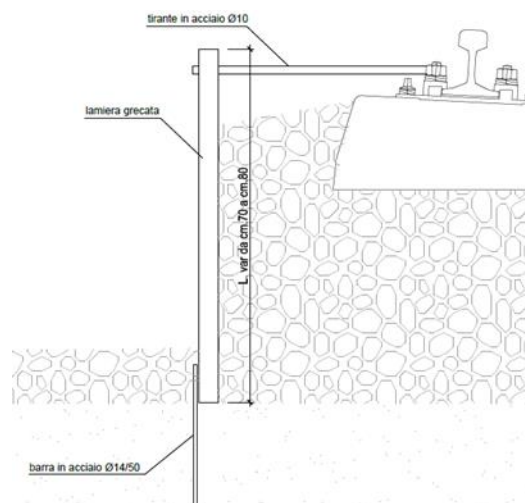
c - Dettaglio del contenimento del ballast
